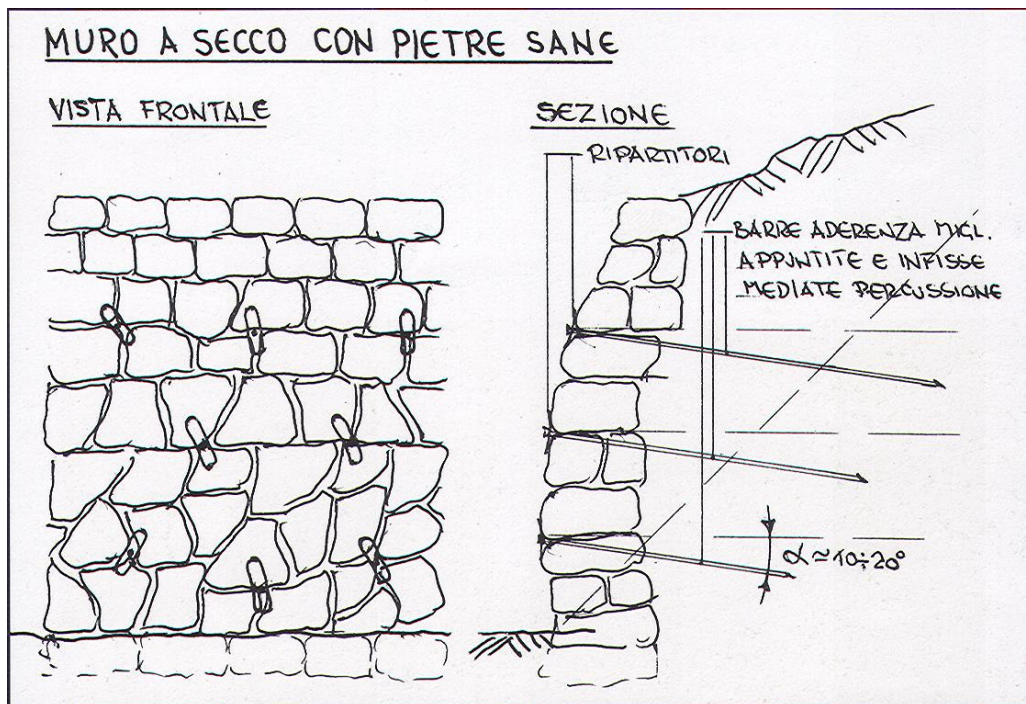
, schema di disposizione delle barre ad aderenza migliorata per muretto a secco.
